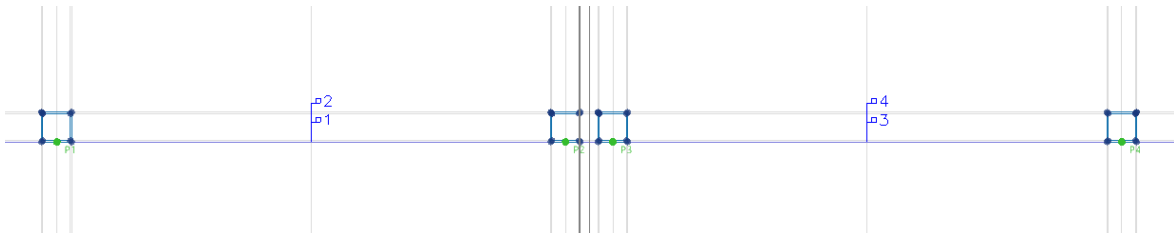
Perfil transversal das vigas longitudinais inferiores
